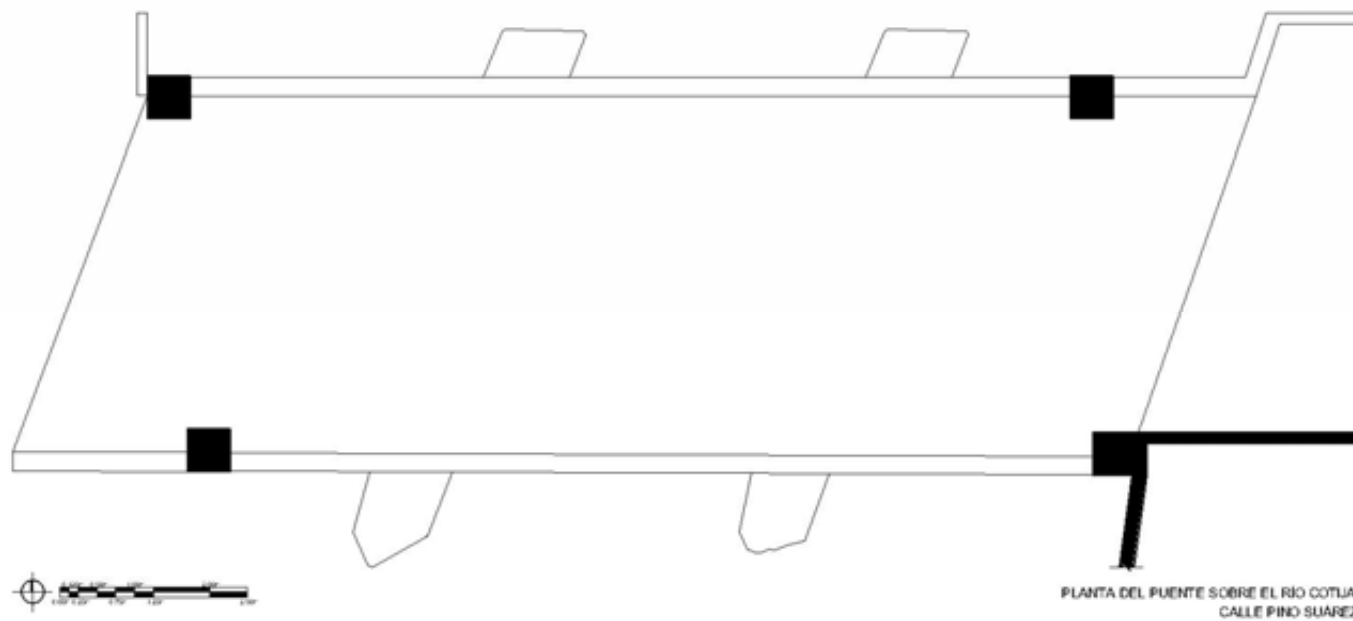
Planta del puente sobre el Río Calle Pino Suárez
